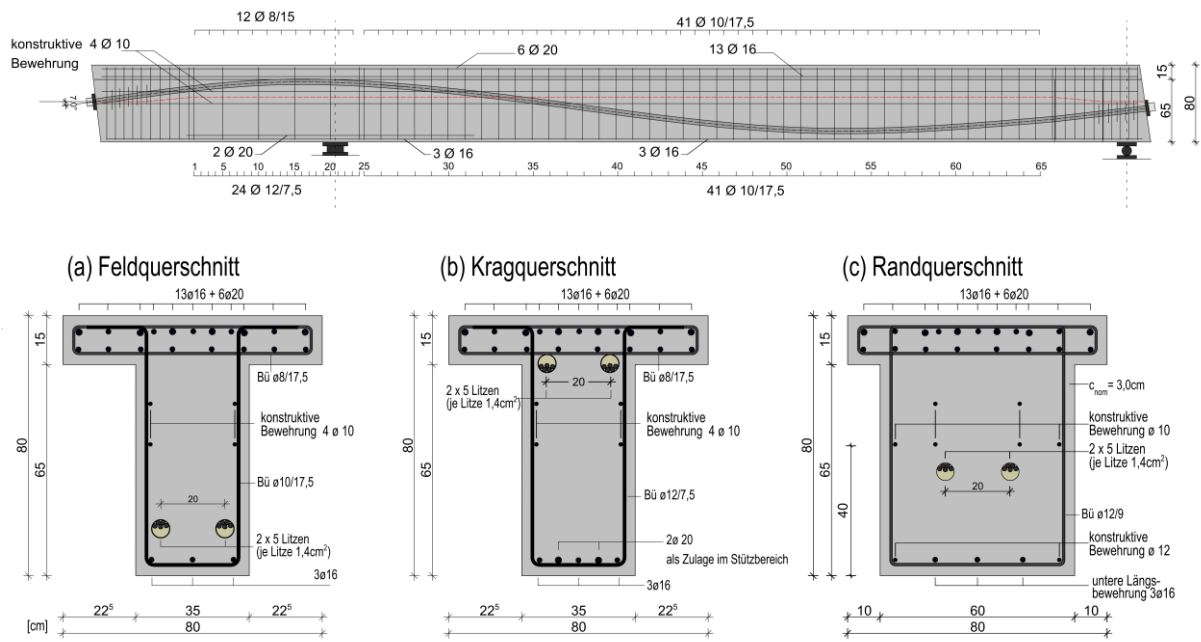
Bewehrungsplan Versuchsträger ETK3
